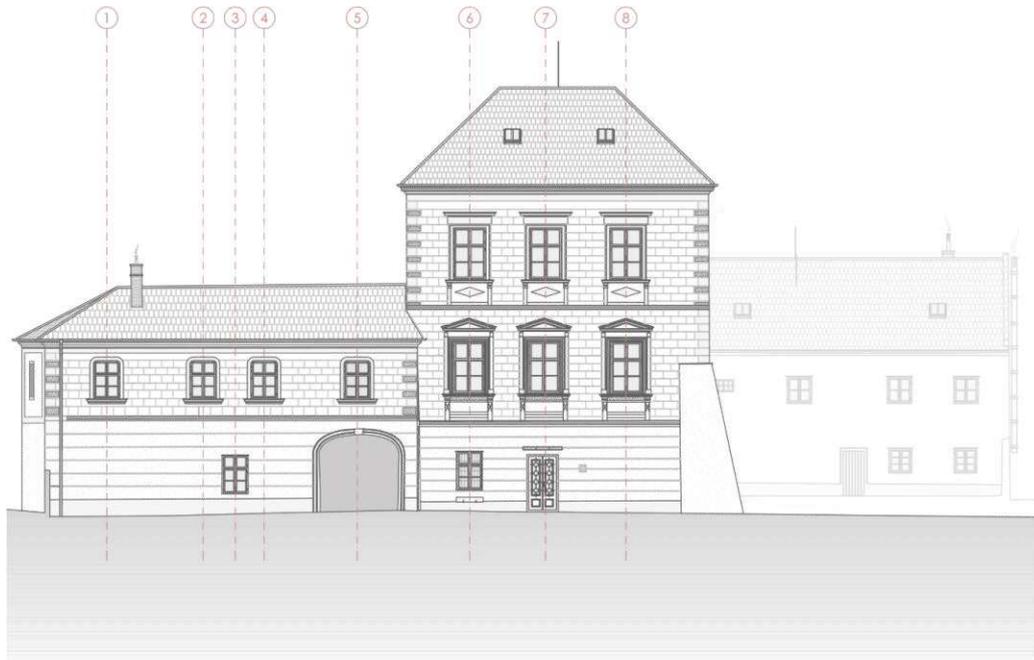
Übersichtsplan der Nordfassade - Osttrakt und Turmgebäude
